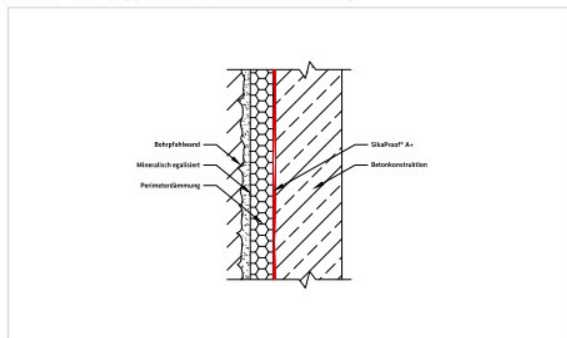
Zweihäufigt geschalte Wand mit Perimeterdämmung
